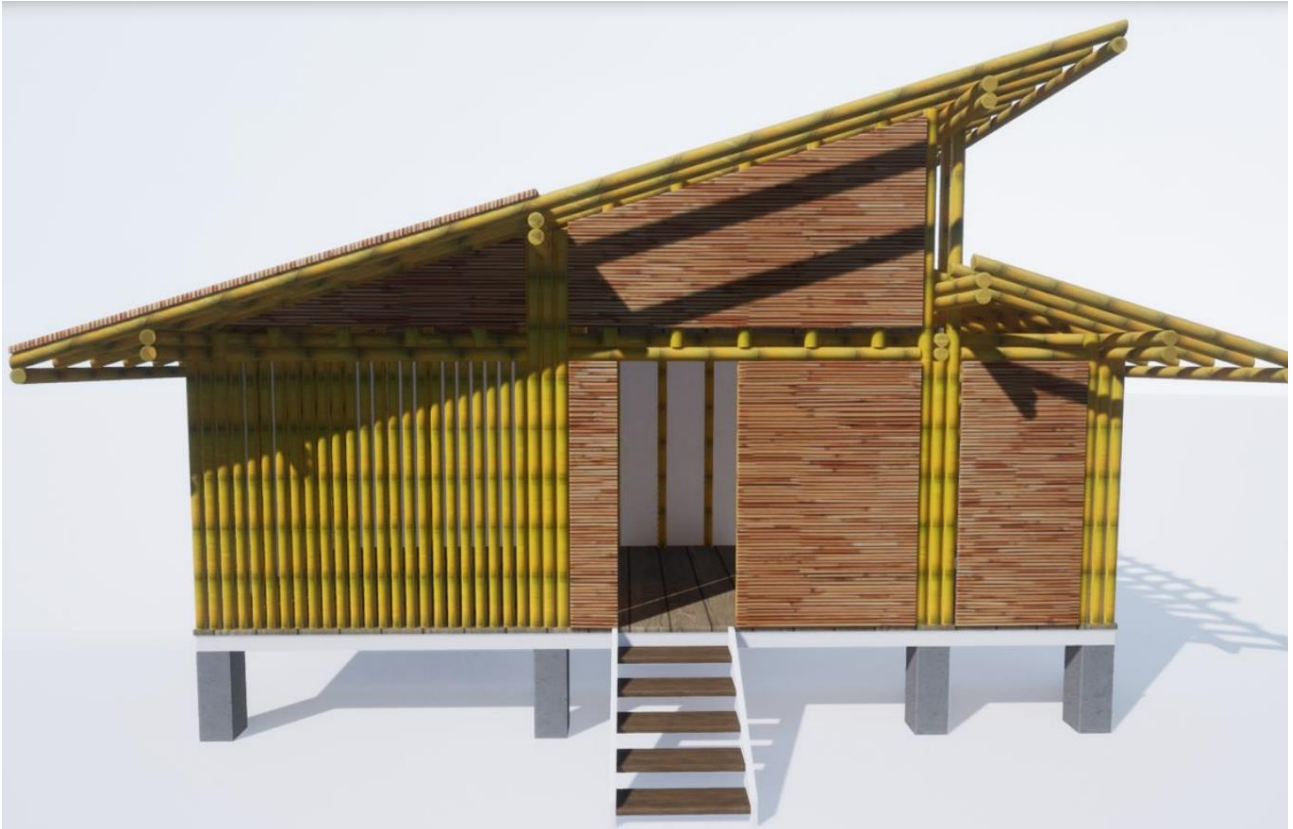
Vista render del prospetto frontale dell'edificio di partenza.
